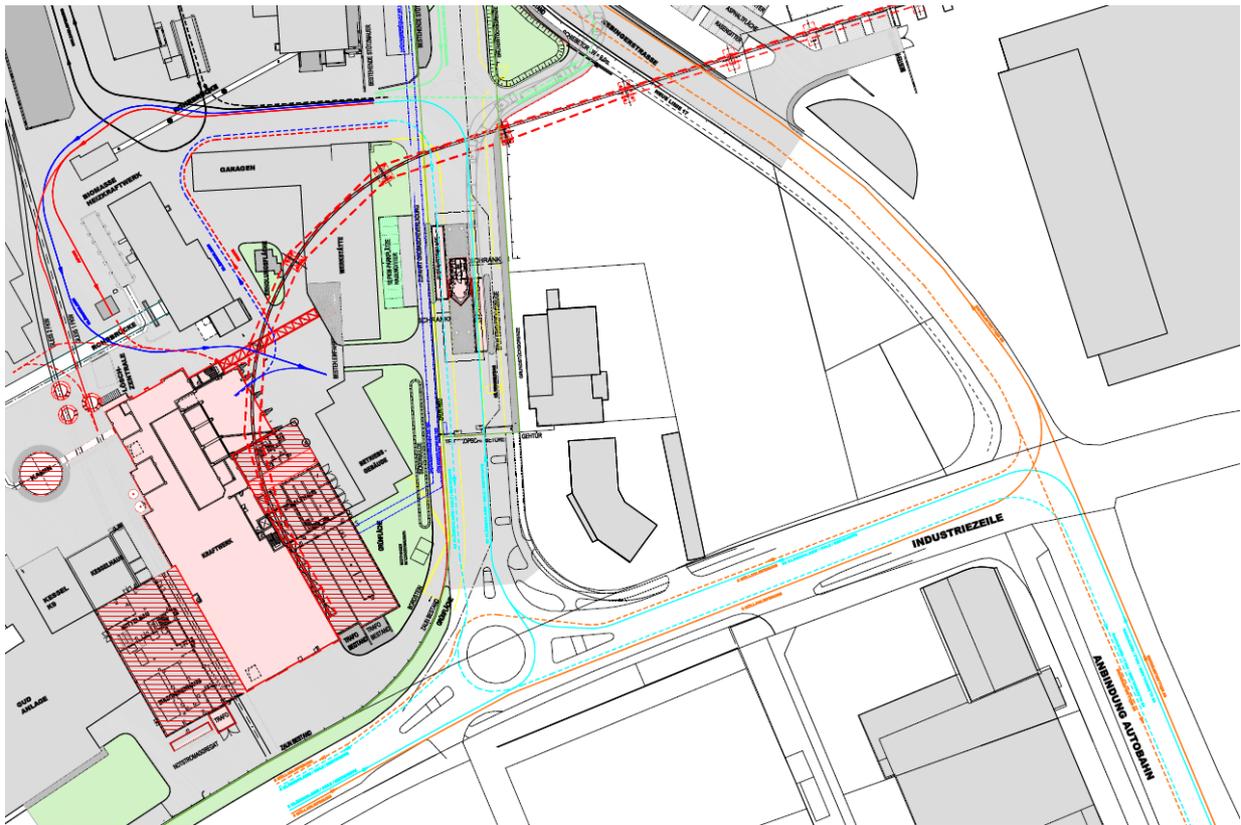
Planausschnitt innerbetriebliche Verkehrsführung Bereich Kraftwerk / Grundlage Plan BHM B014/ C09
